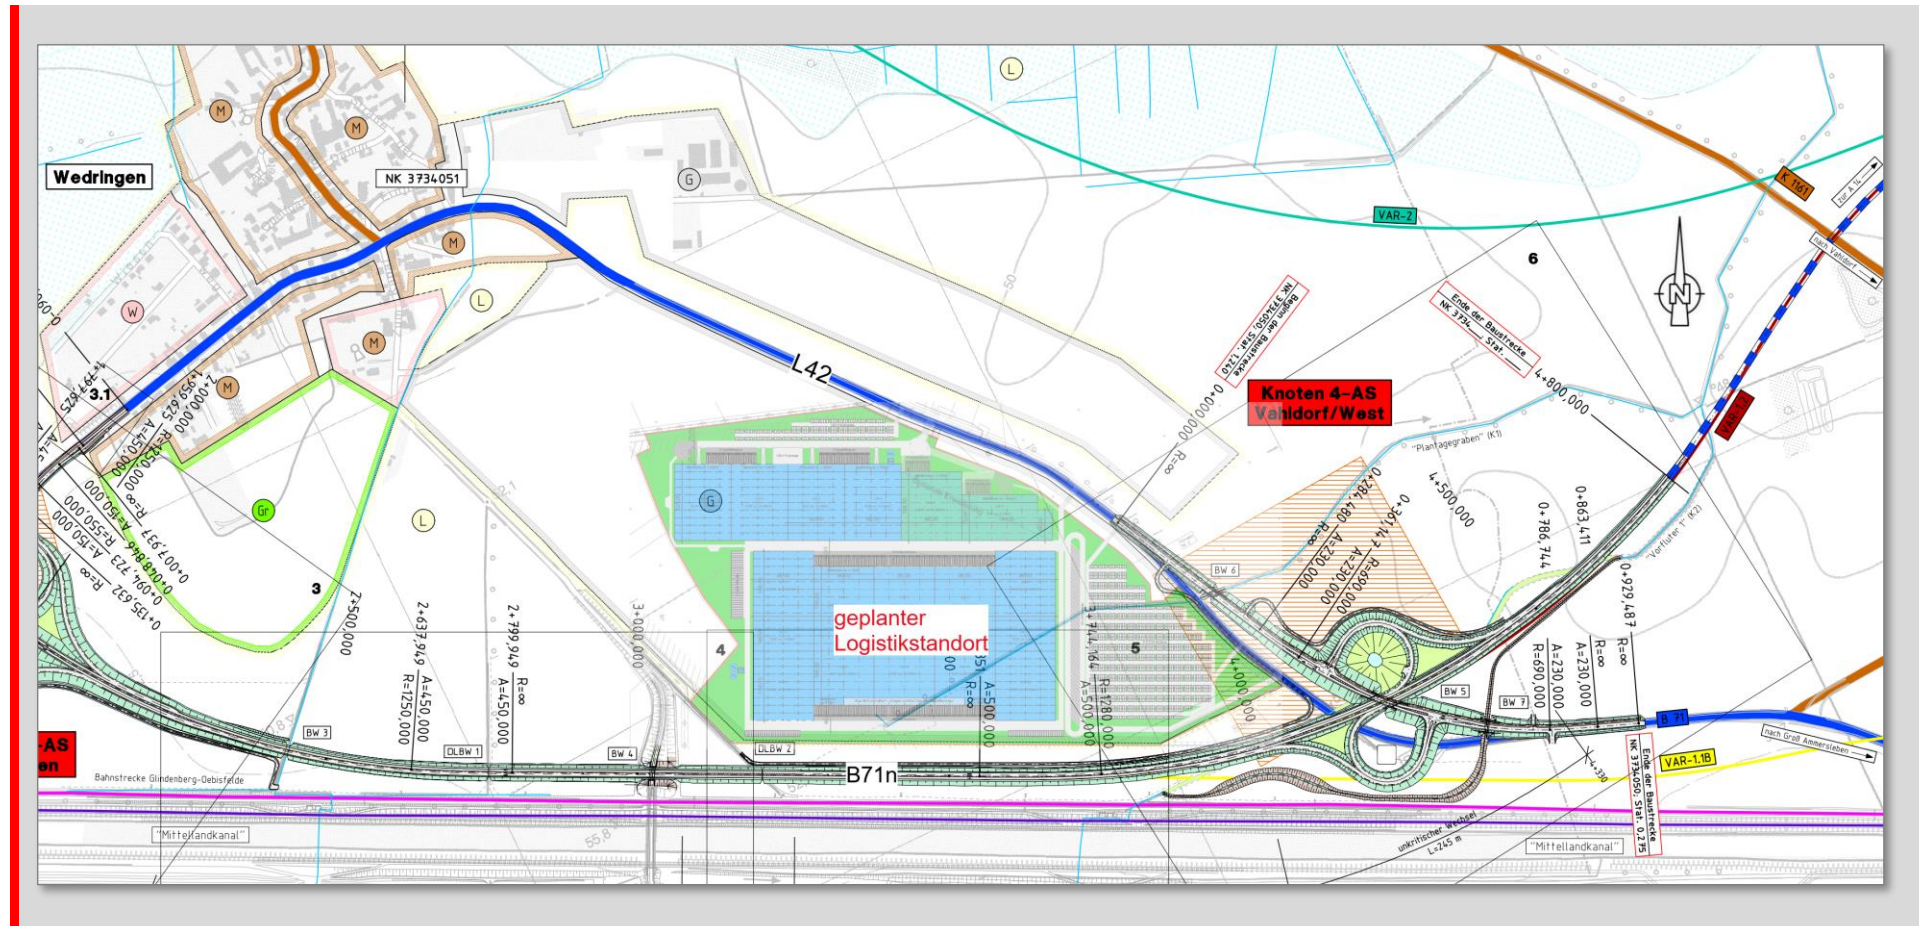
Übersichtslageplan des Standortes mit Knotenpunkt 4;
